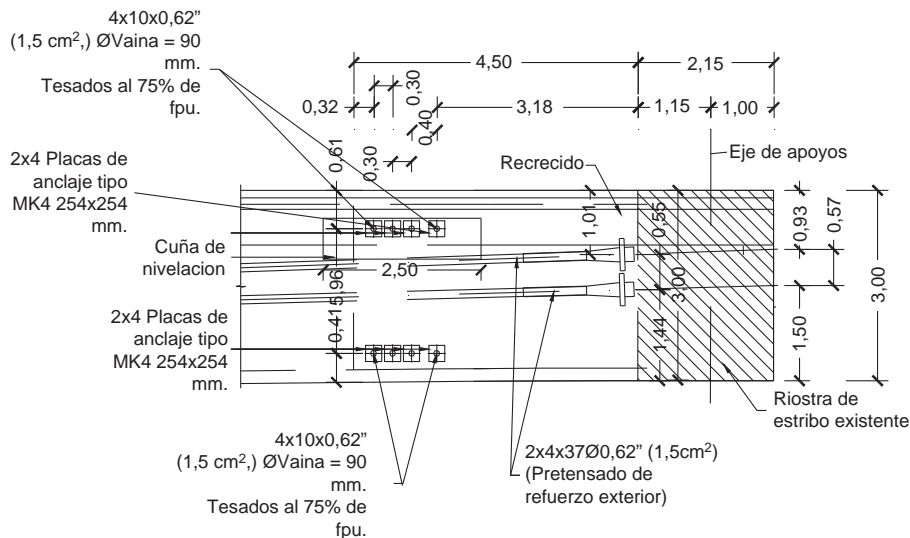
Alzado longitudinal de la riostra de anclaje del pretensado exterior situado en el interior del cajón, del estribo del lado Galicia.
